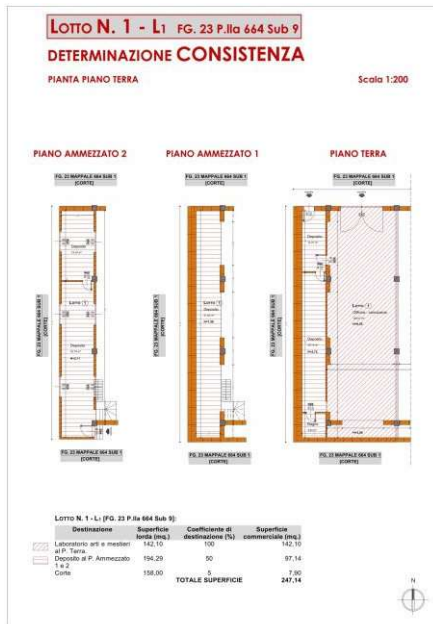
Determinazione consistenza Lotto L₁ (ALL. 11).
